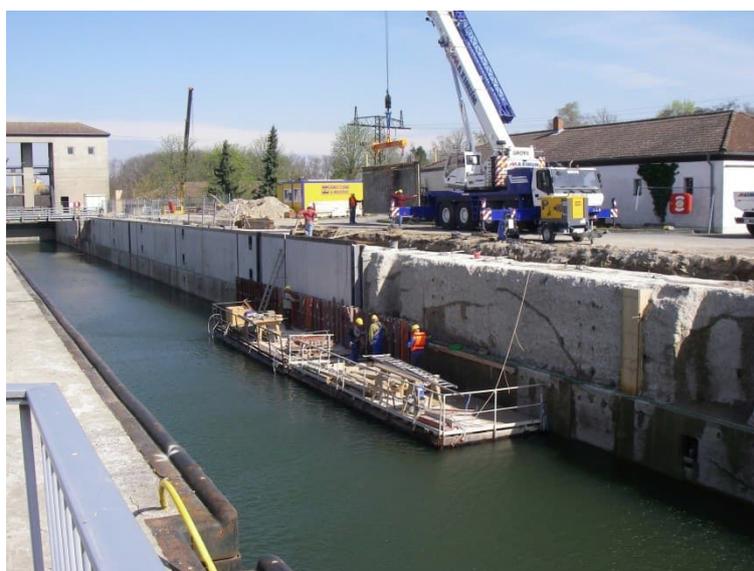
Instandsetzung der Kammerwände der Schleuse Wedtlenstedt mit Fertigteilen unter Betrieb (Quelle: BAW)
